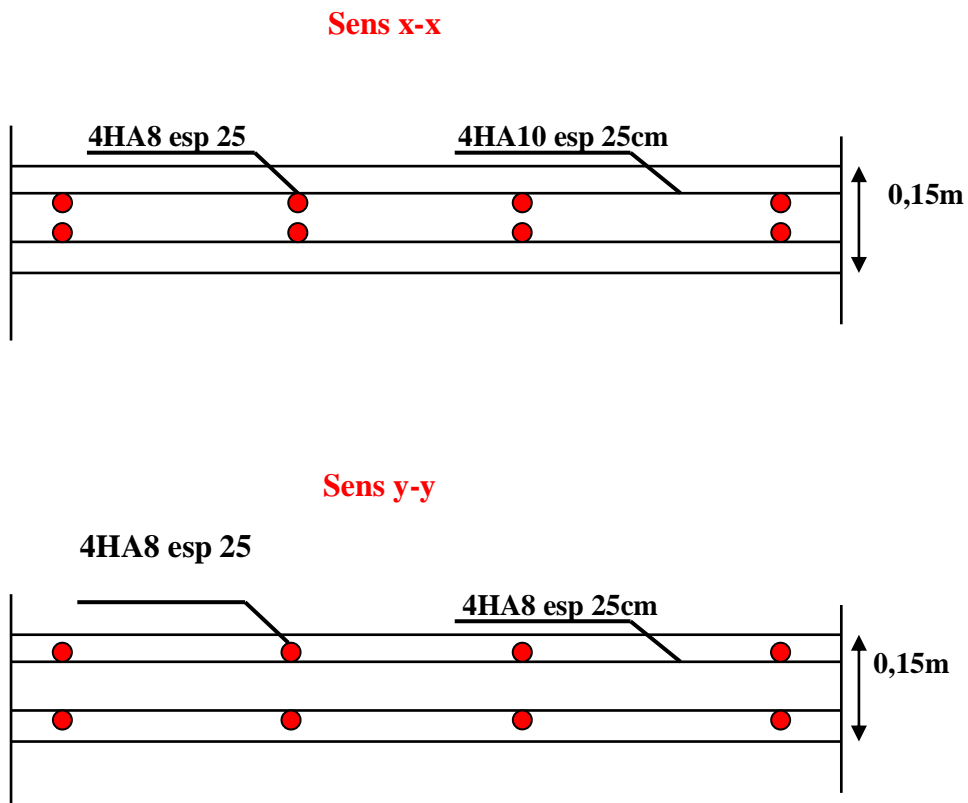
Schéma du ferrailage de la dalle salle machine.
